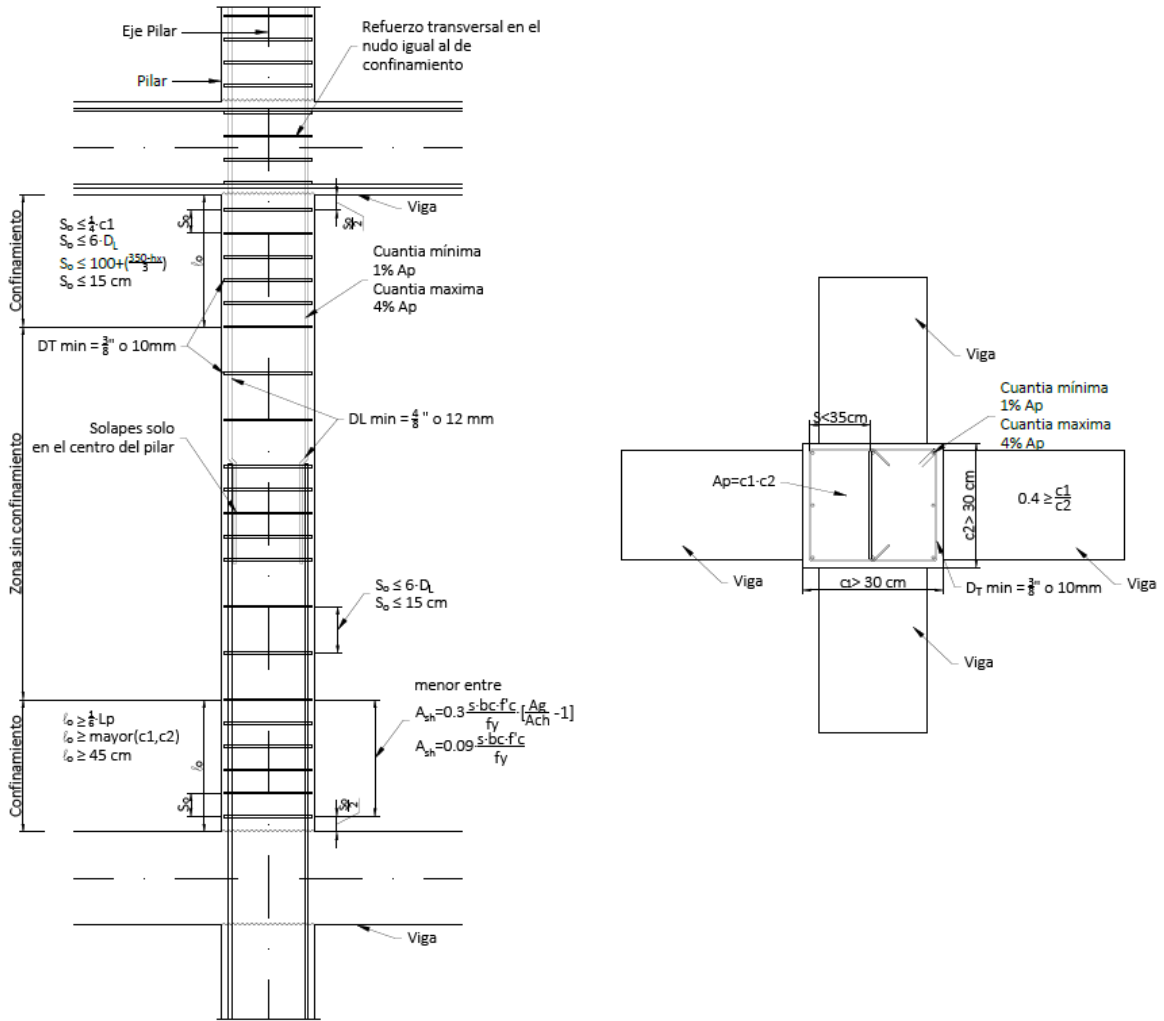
Detalle general estructural del PILAR para ductilidad DES
